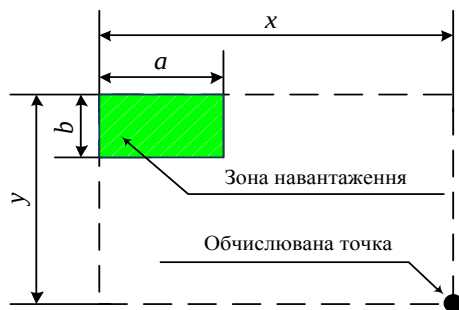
Схема передачі навантажень на ґрунтову засіпку при прямокутній формі передачі навантажень (Pettersson, Leander, & Hansing, 2002; Pettersson, & Sundquist, 2007)
